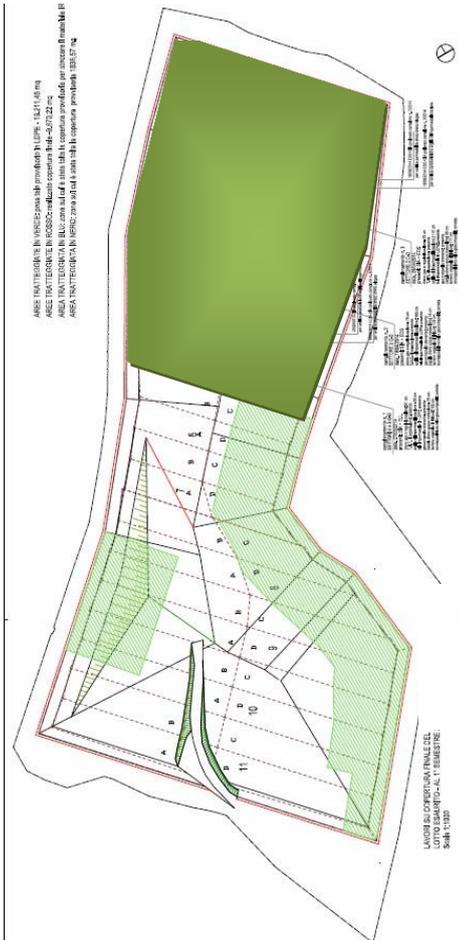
Planimetria stato avanzamento lavori di copertura finale
